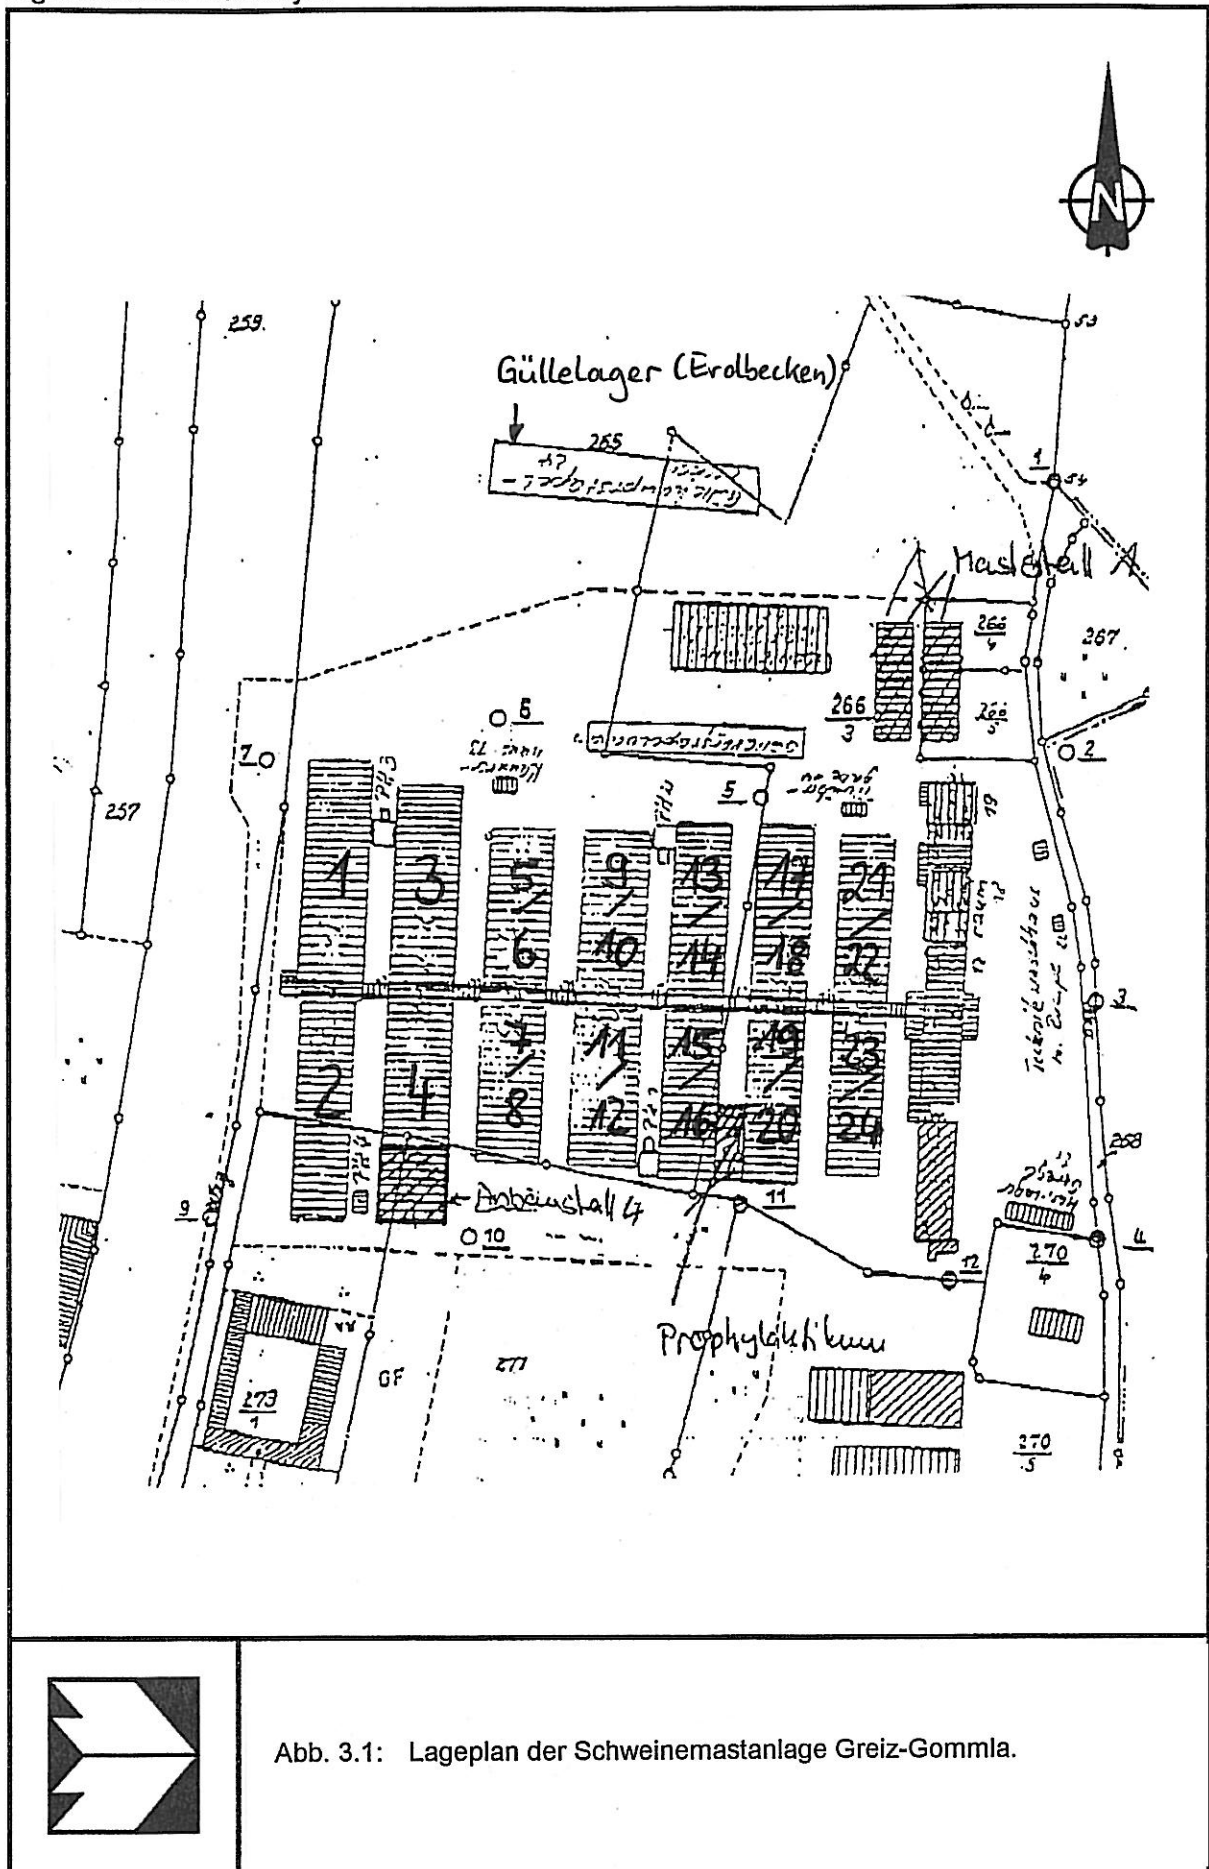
Lageplan der Schweinemastanlage Greiz-Gommla.
